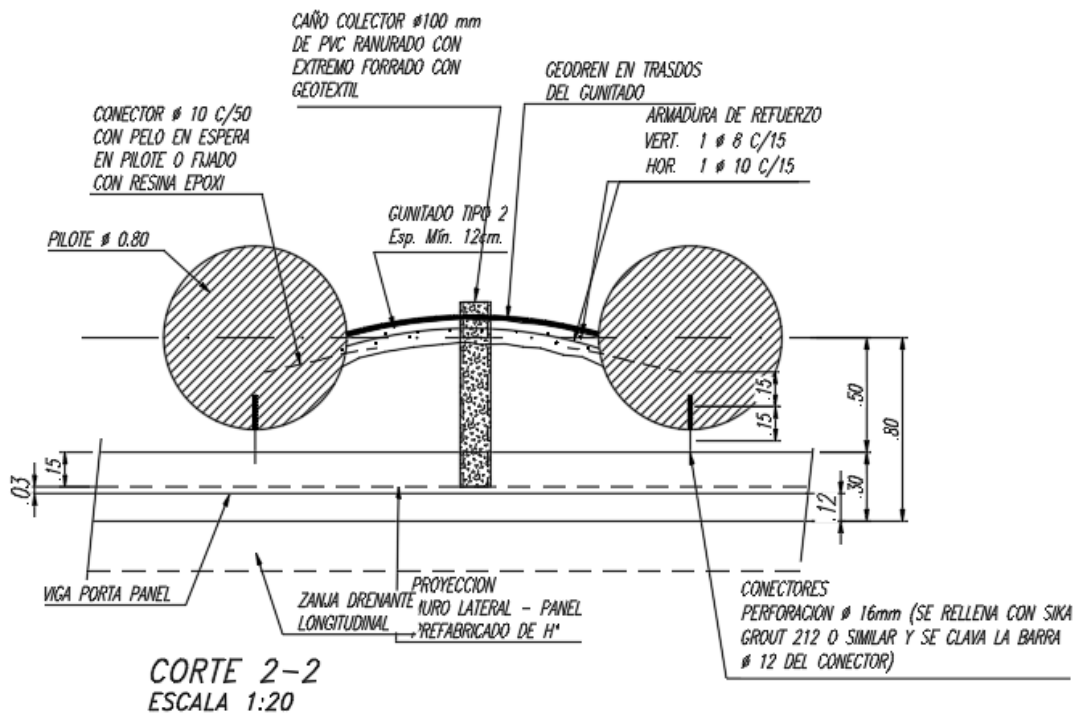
“Corte horizontal de pilotes y gunitado”
